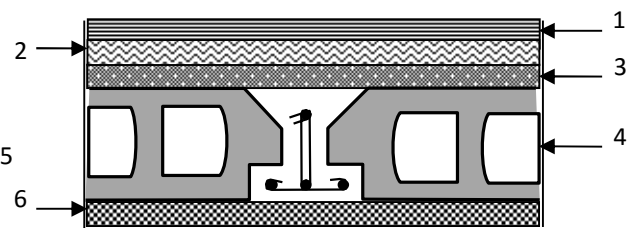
Coupe transversale dans Le plancher étage courant.
